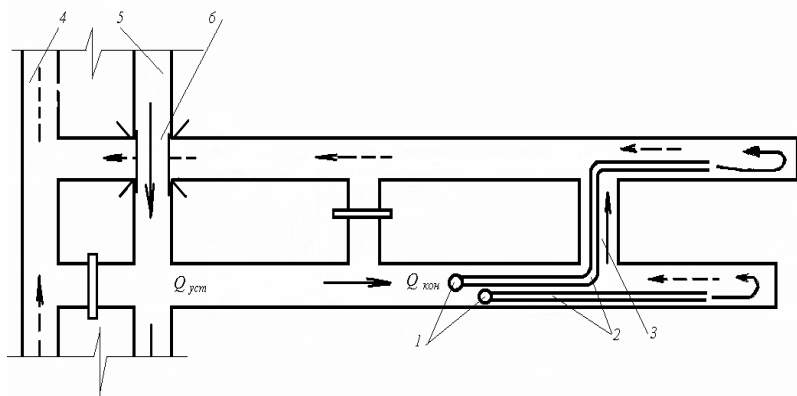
Схема проветривания парных выработок при их проведении: 1 – вентиляторы, работающие на нагнетание; 2 – трубопроводы; 3 – последняя сбойка; 4 – выработка с исходящей струей; 5 – выработка со свежей струей; 6 – кроссинг
